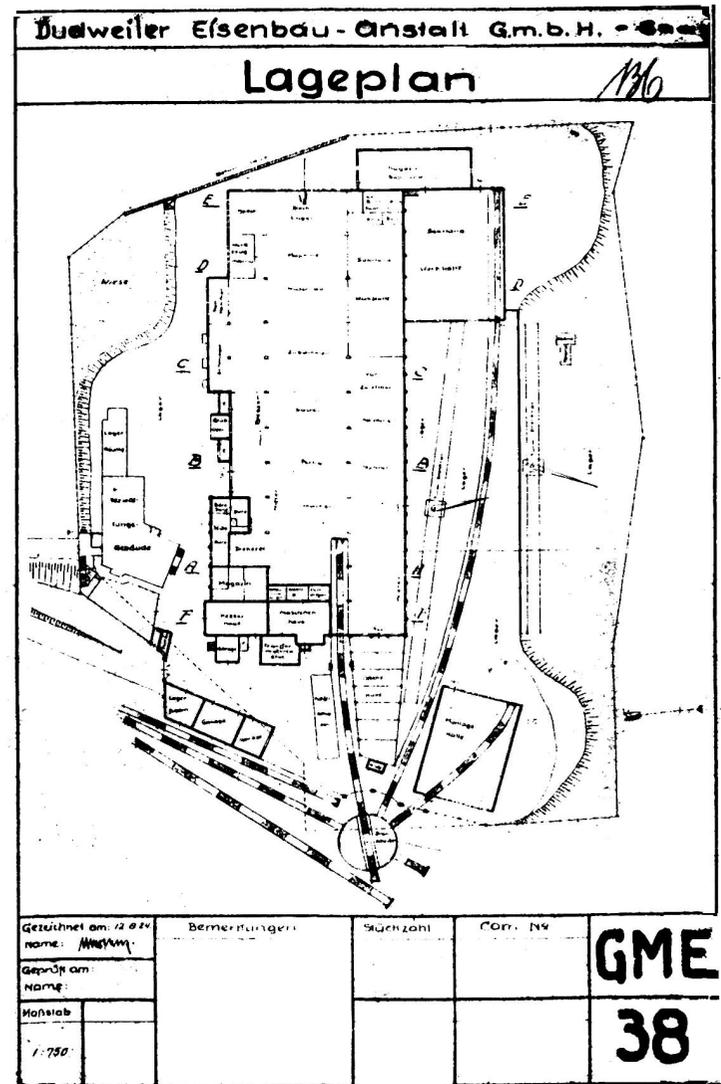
Lageplan der DEBA, erstellt am 12.8.1924
